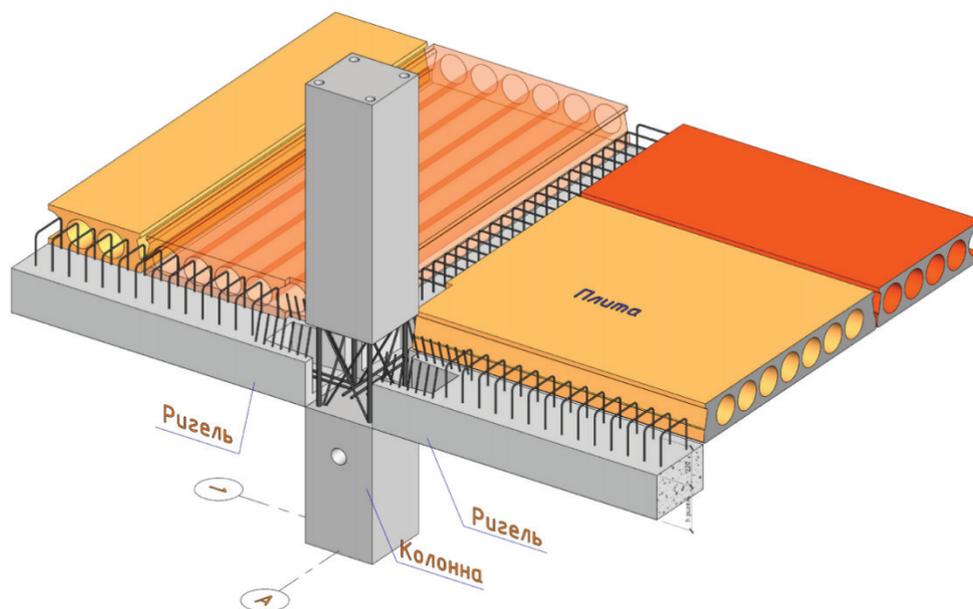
Узел соединения «Колонна-Ригель-Плита»
